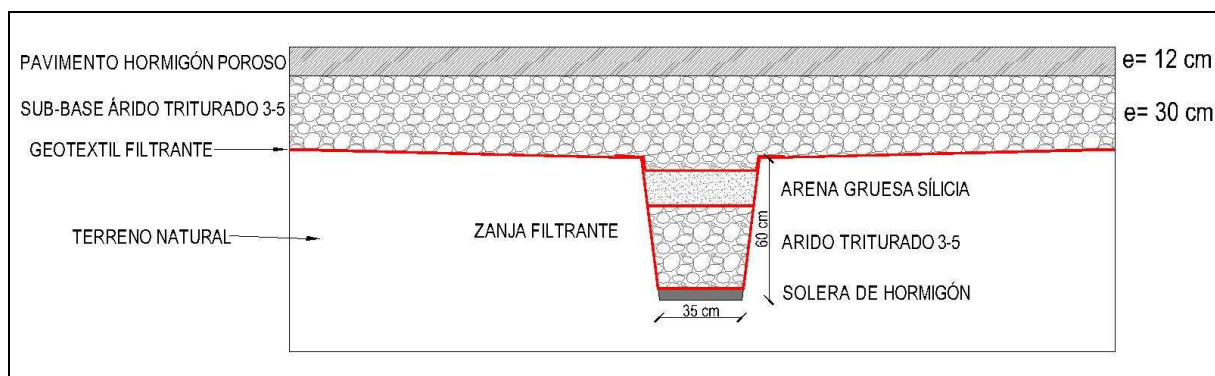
Sección pavimento permeable de hormigón poroso para estacionamiento
